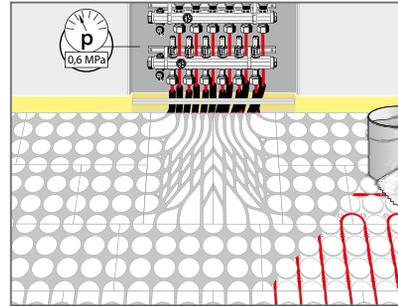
Druckprobe, anschließend Verspachteln der Systemfläche mit Flexklebe
